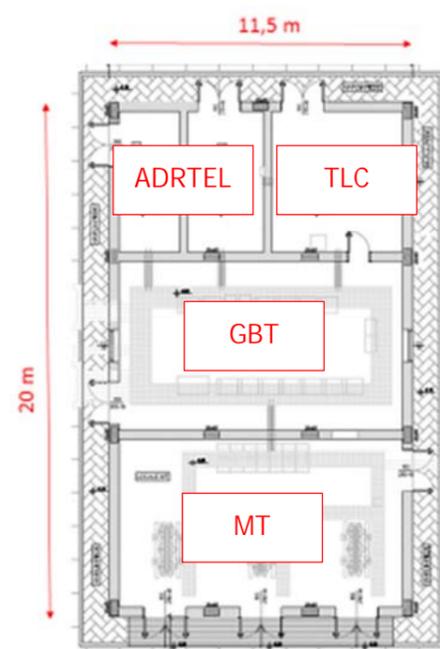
Vista in pianta della cabina impianti dell'Apron Est
